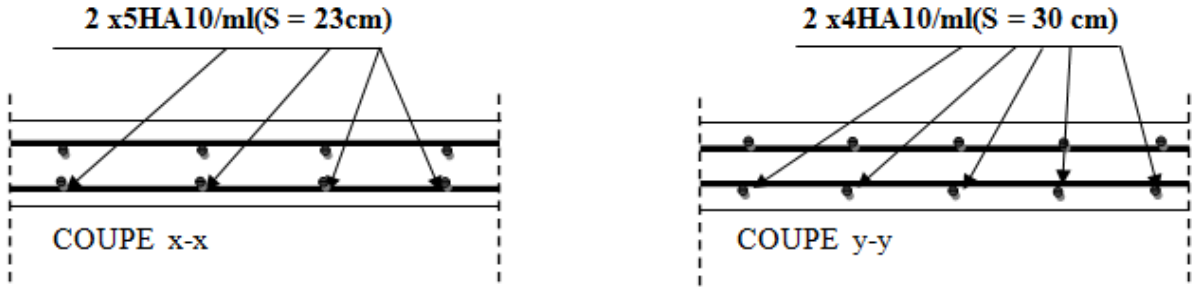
Ferrailage de la dalle pleine de la salle machine.
